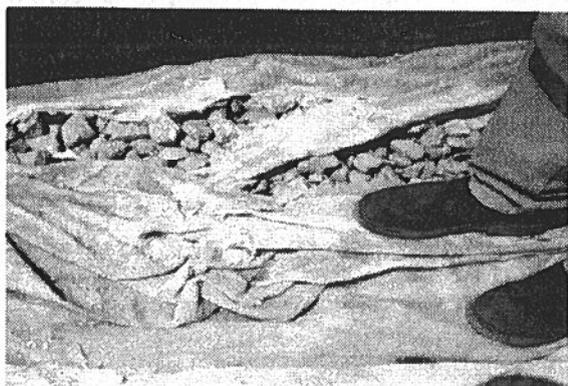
Recolha de amostra e ensaio de corte e arranque de soldaduras (Lopes, 2005)
